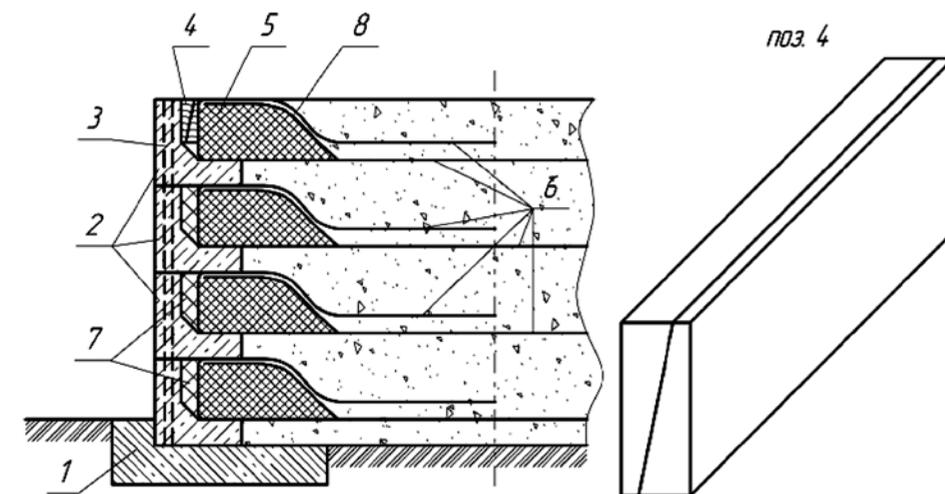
Лицевая стенка из сборных ж/б блоков с армирующими элементами из георешетки PVA (поливинилалкоголь):
